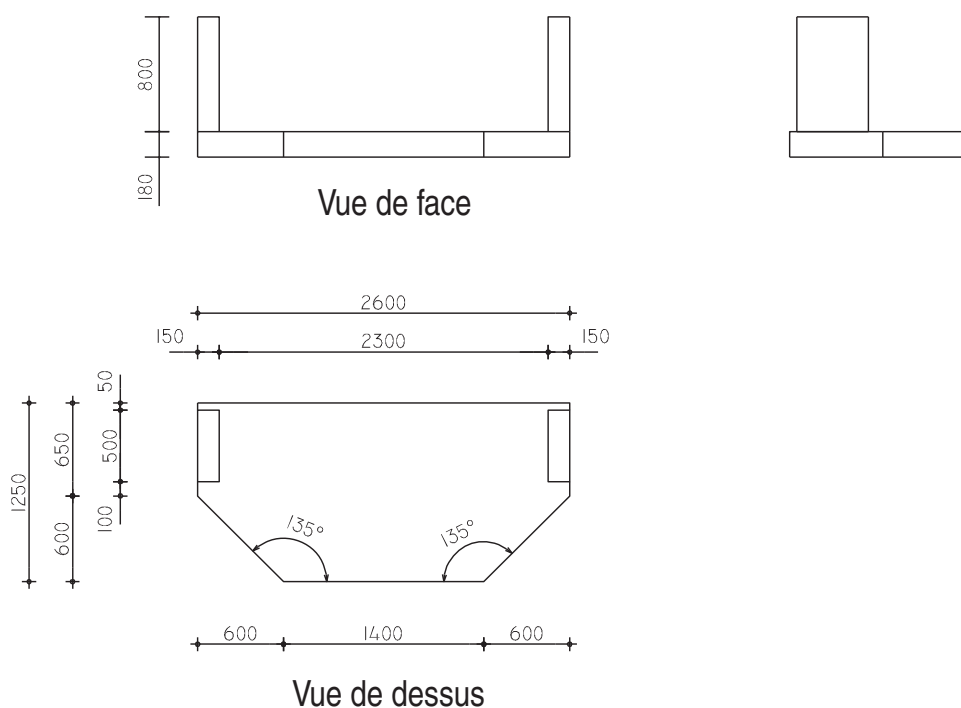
Balcon coté en millimètres, défini en vue de face (ou élévation) et vue de dessus (ou plan)
